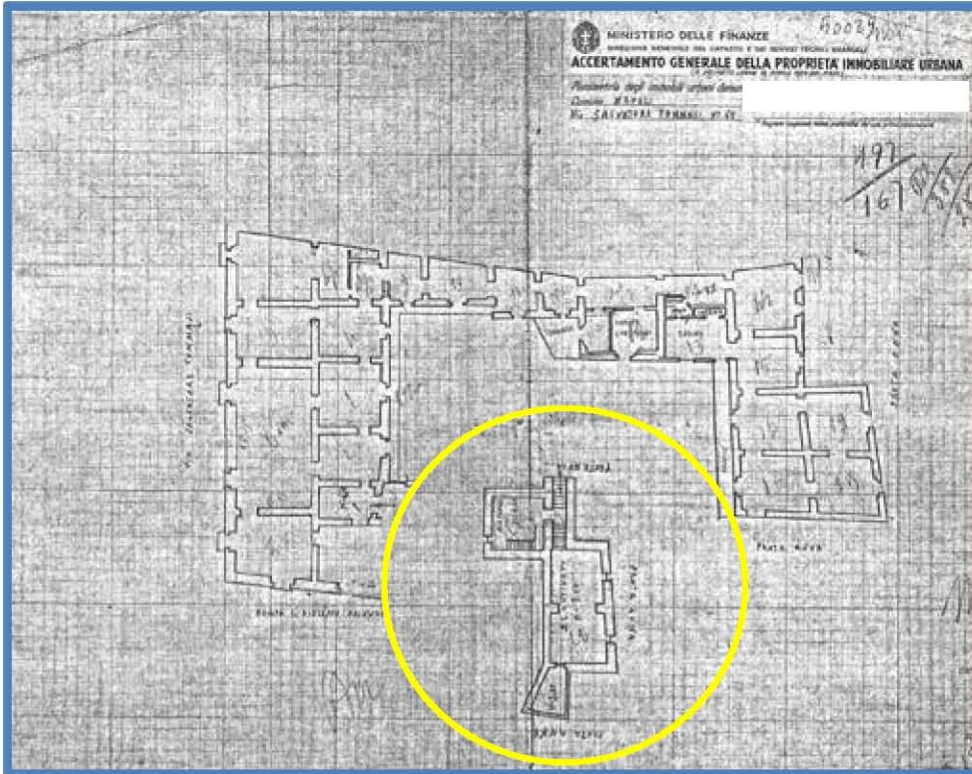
stralcio della Planimetria catastale originaria d'impianto
